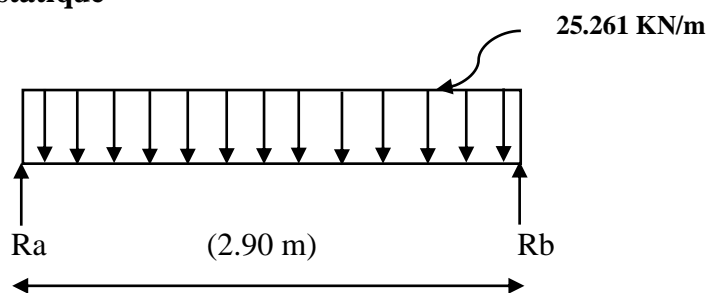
Schéma statique de la poutre palière a l’ELU.
